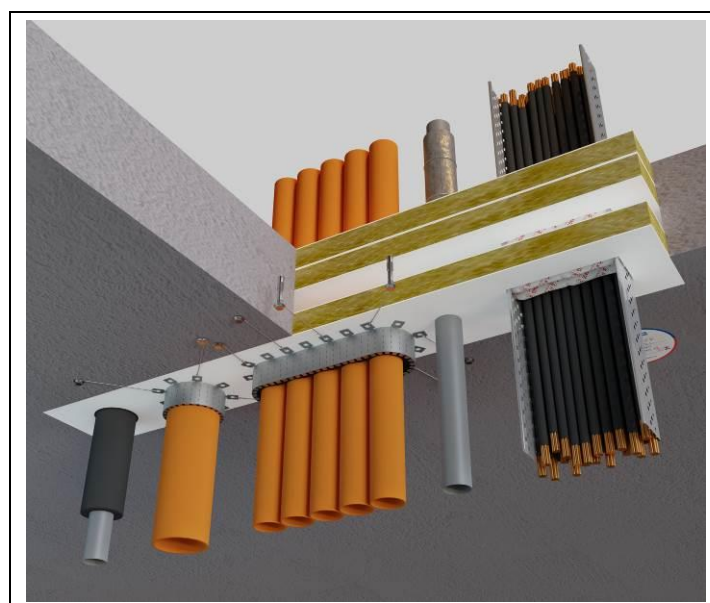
Exemple de joint AF PANEL dans un plancher rigide (D).
